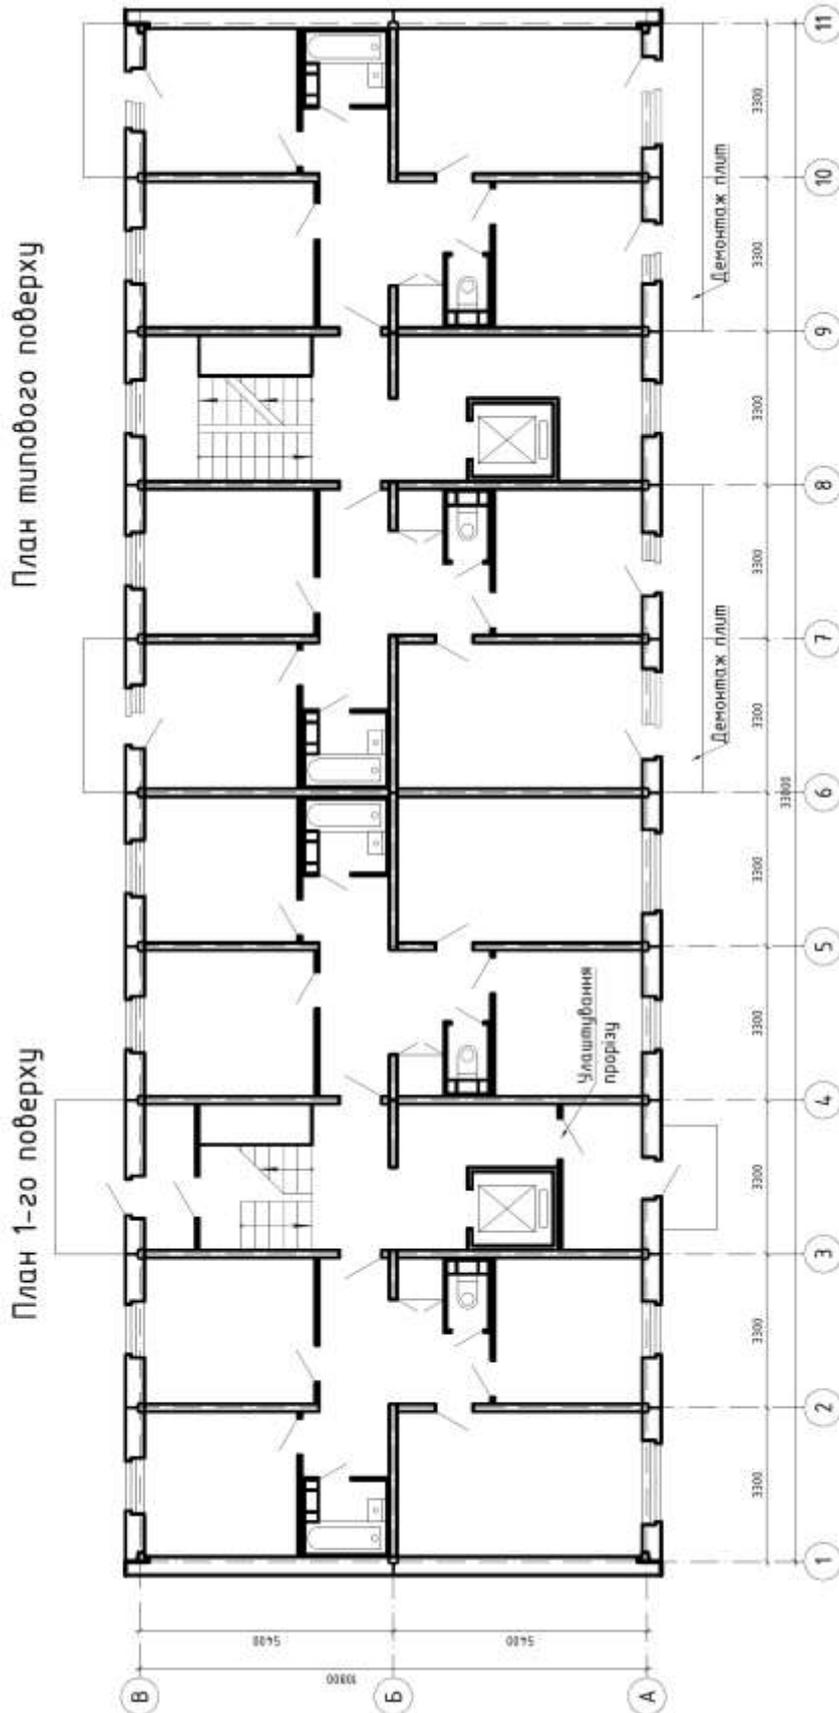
Варіант типового дев'ятиповерхового житлового будинку (плани першого та типового поверхів)
